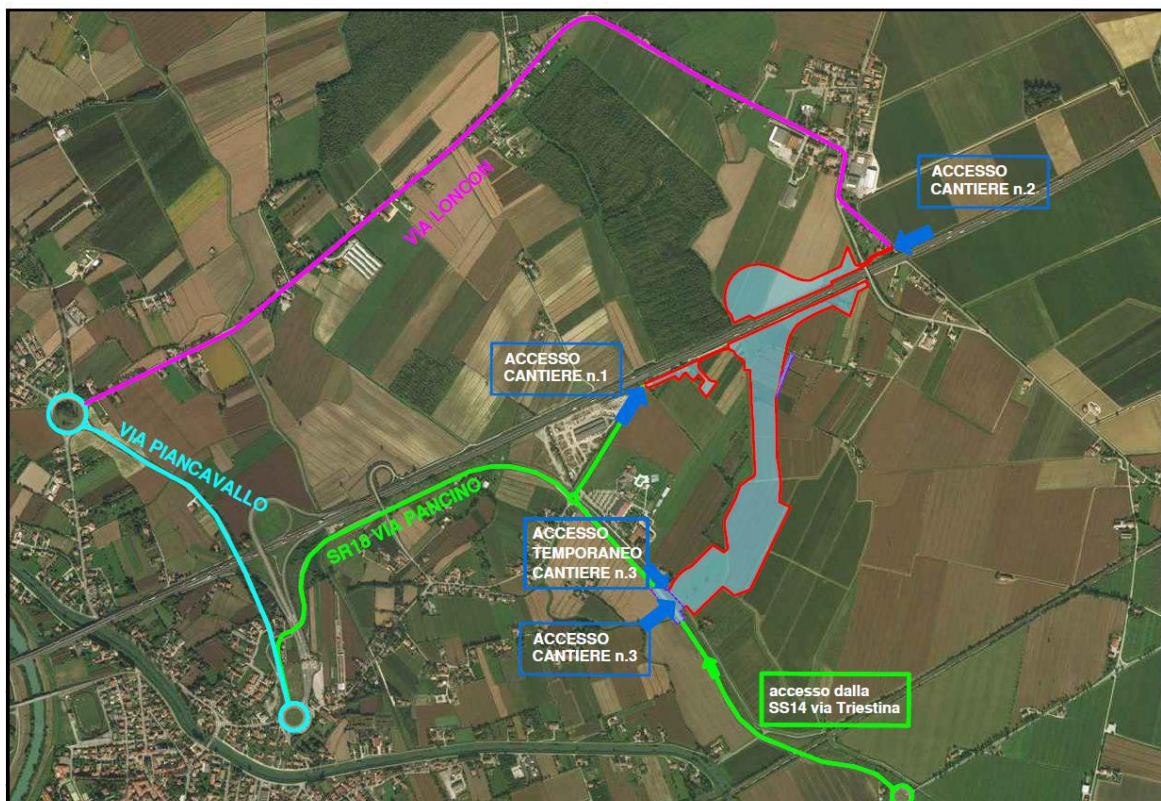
Schema viabilità di cantiere estratta da elab. V.03.00.0.0
